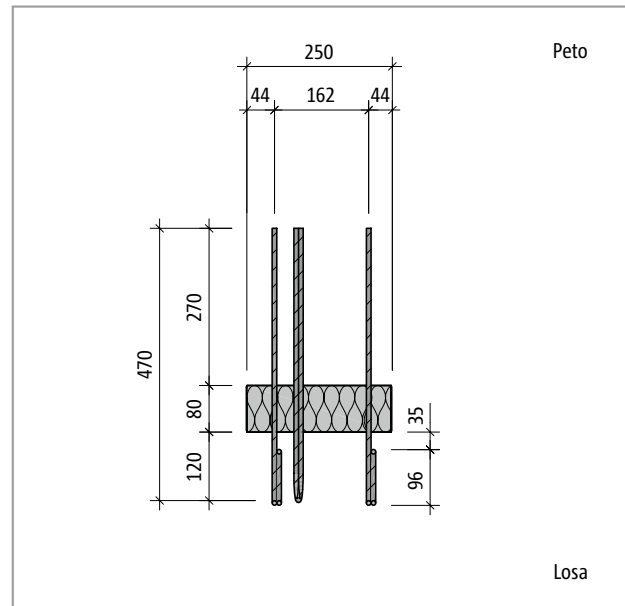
Schöck Isokorb® T tipo A-MM1-X80: Vista del producto
